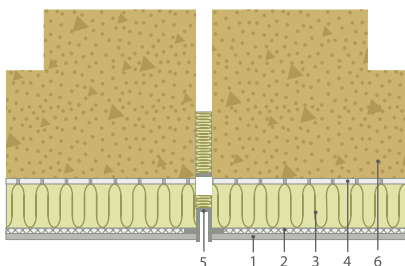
Решение деформационных швов в системах наружного утепления зданий:
